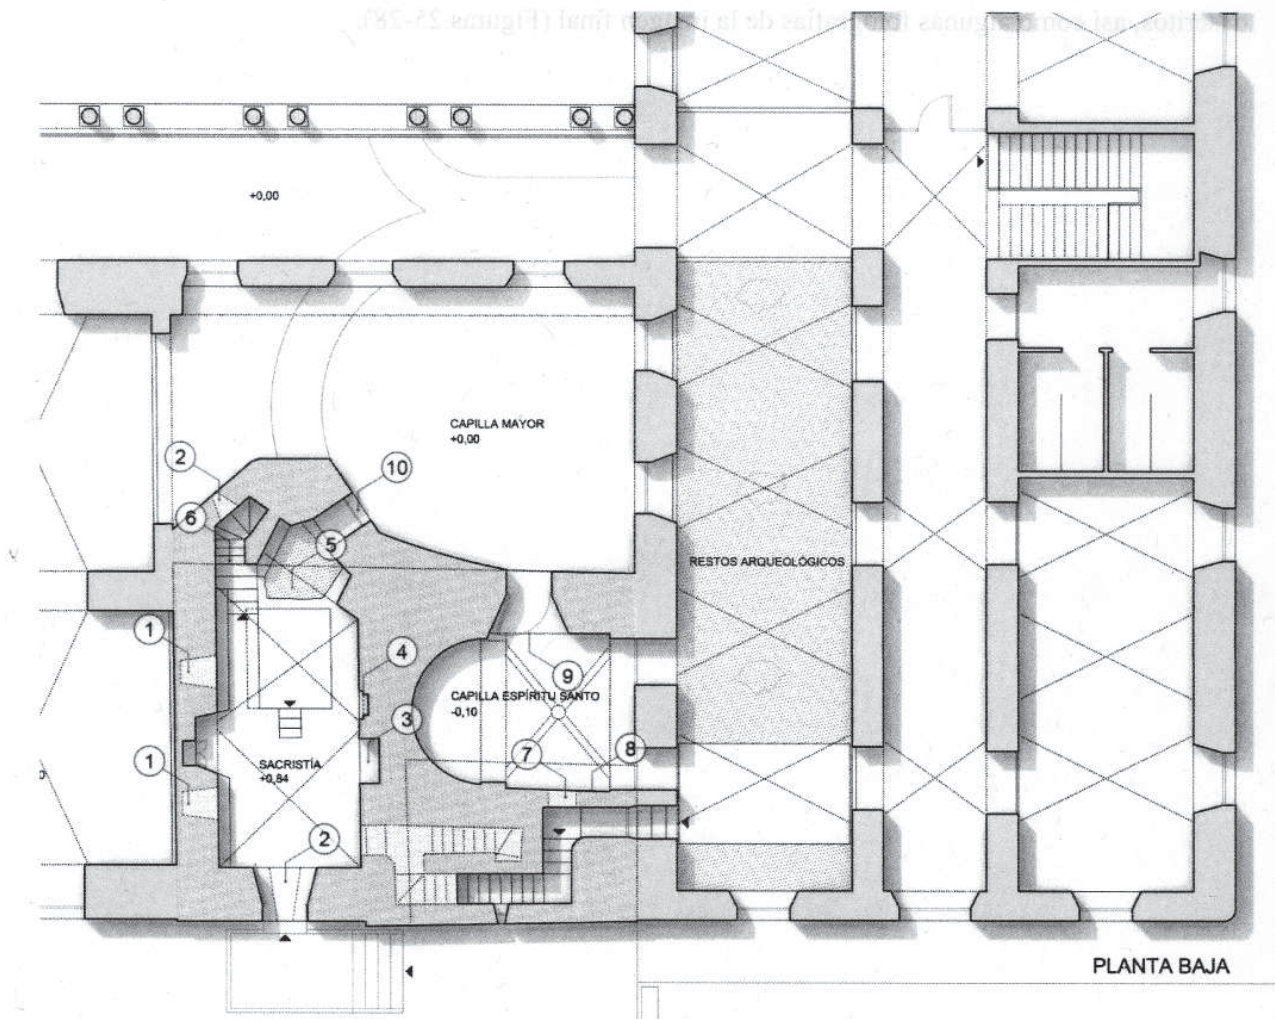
Planta baja. Con el número 10 se identifica la situación de la ventana nervada gótico mudéjar que fue cegada al construir la torre-sacristía y la torre-escalera adosada al ábside de la capilla mayor
